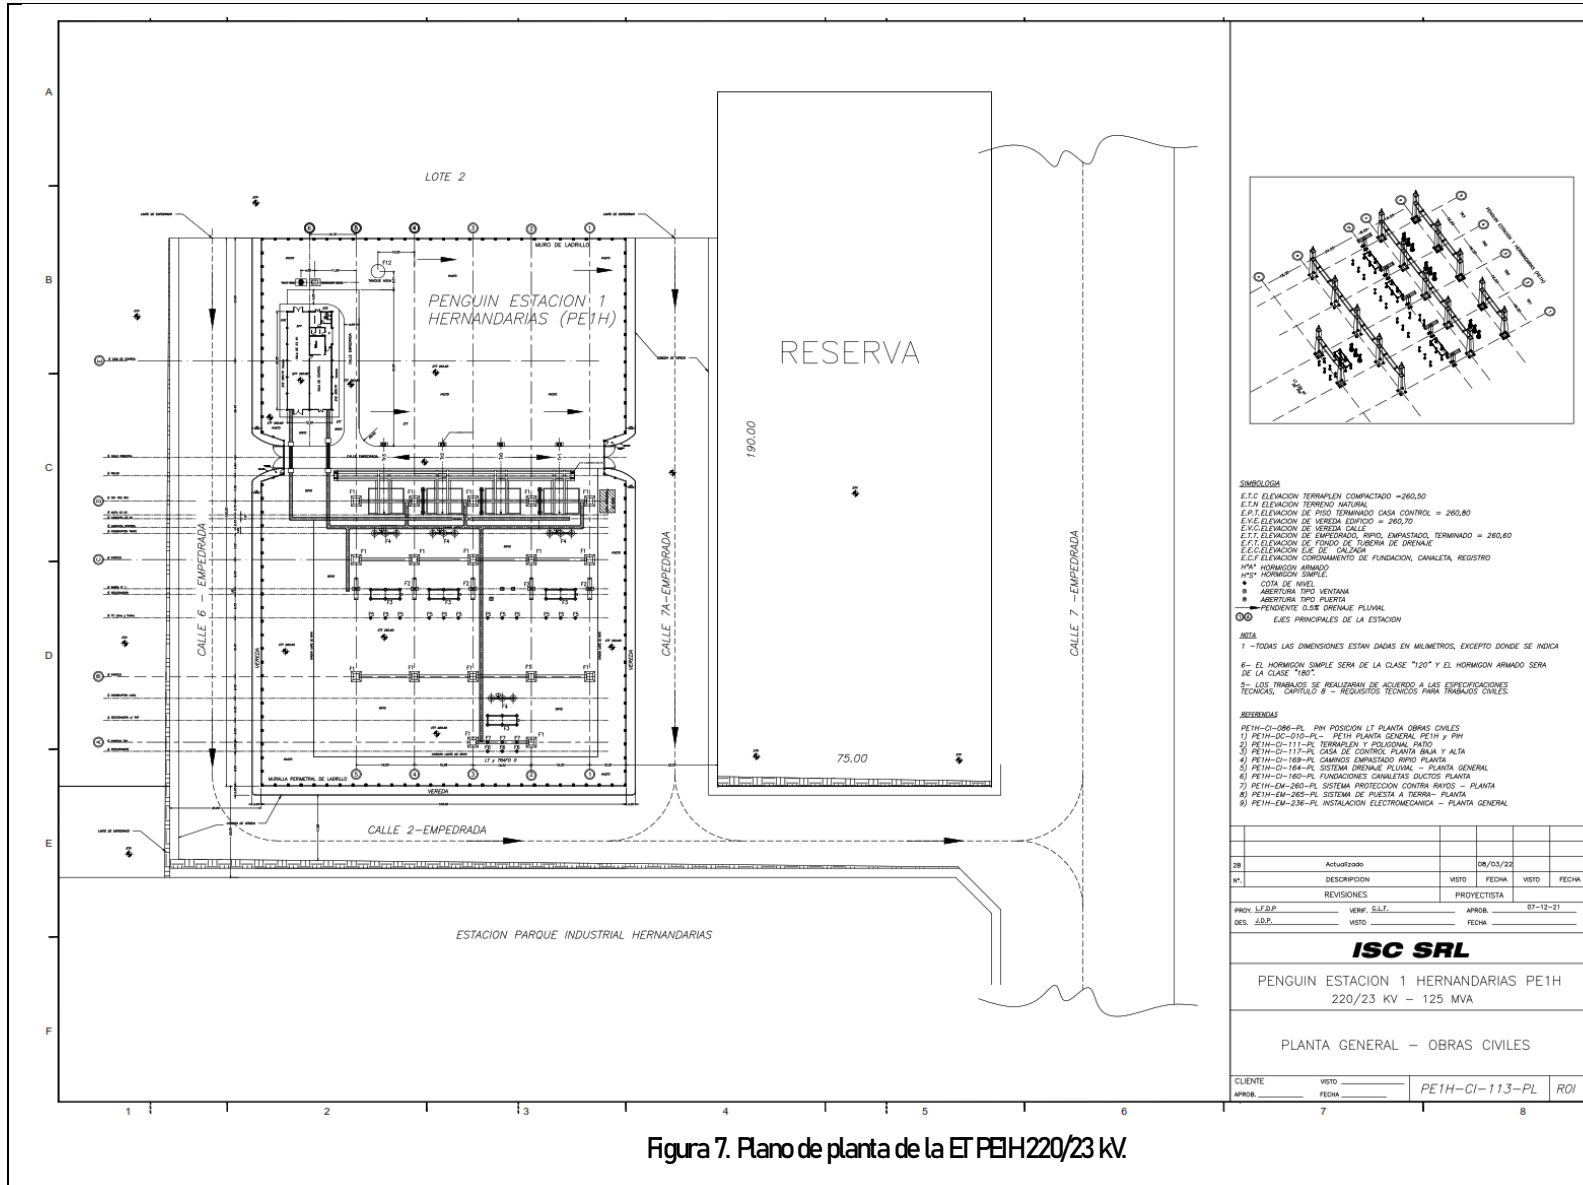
Plano de planta de la ET PE1H220/23 kv.
